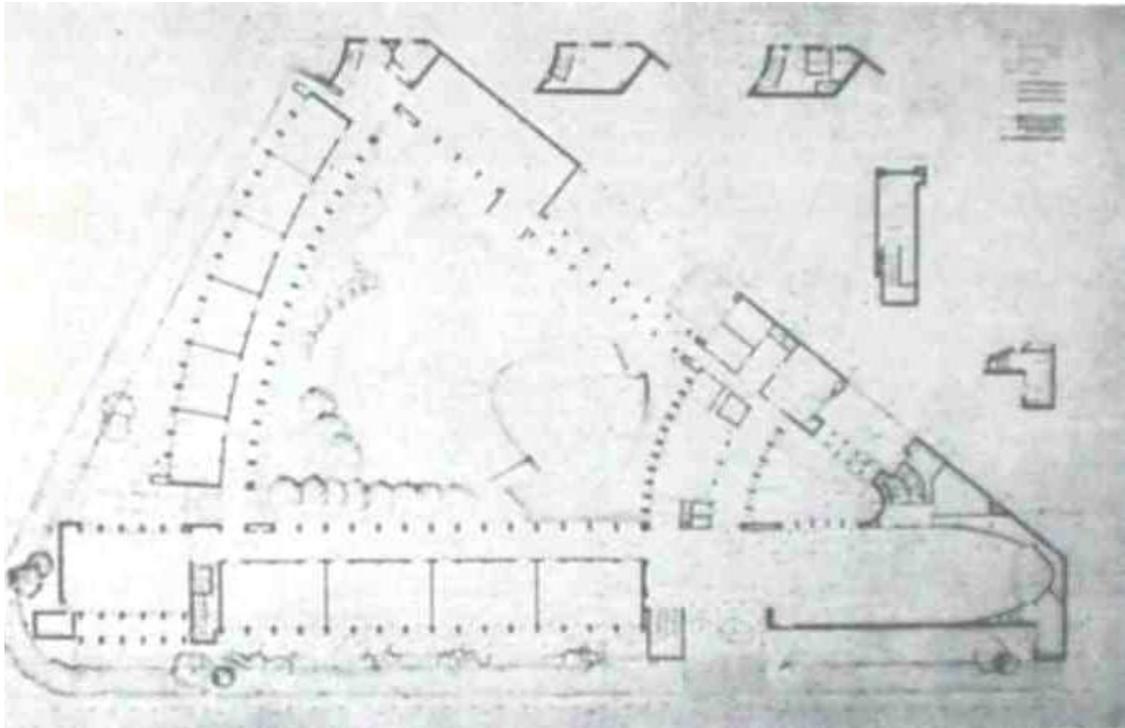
Facultad de Arquitectura. Planta Baja y sectores de
